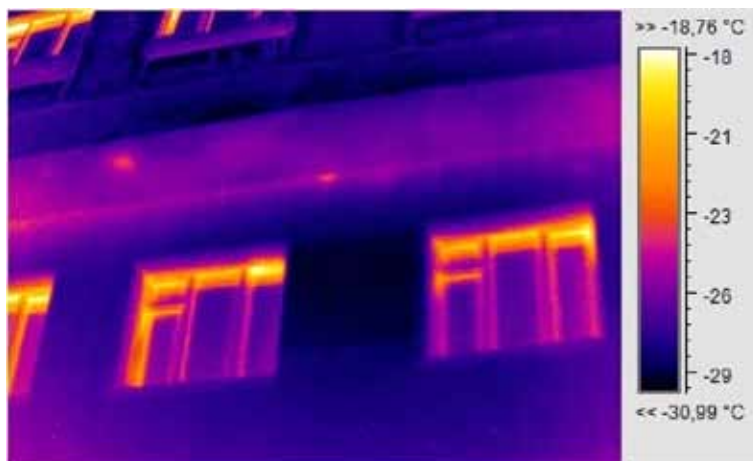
Фасад УЛК (стык 1-го и 2-го этажа)
